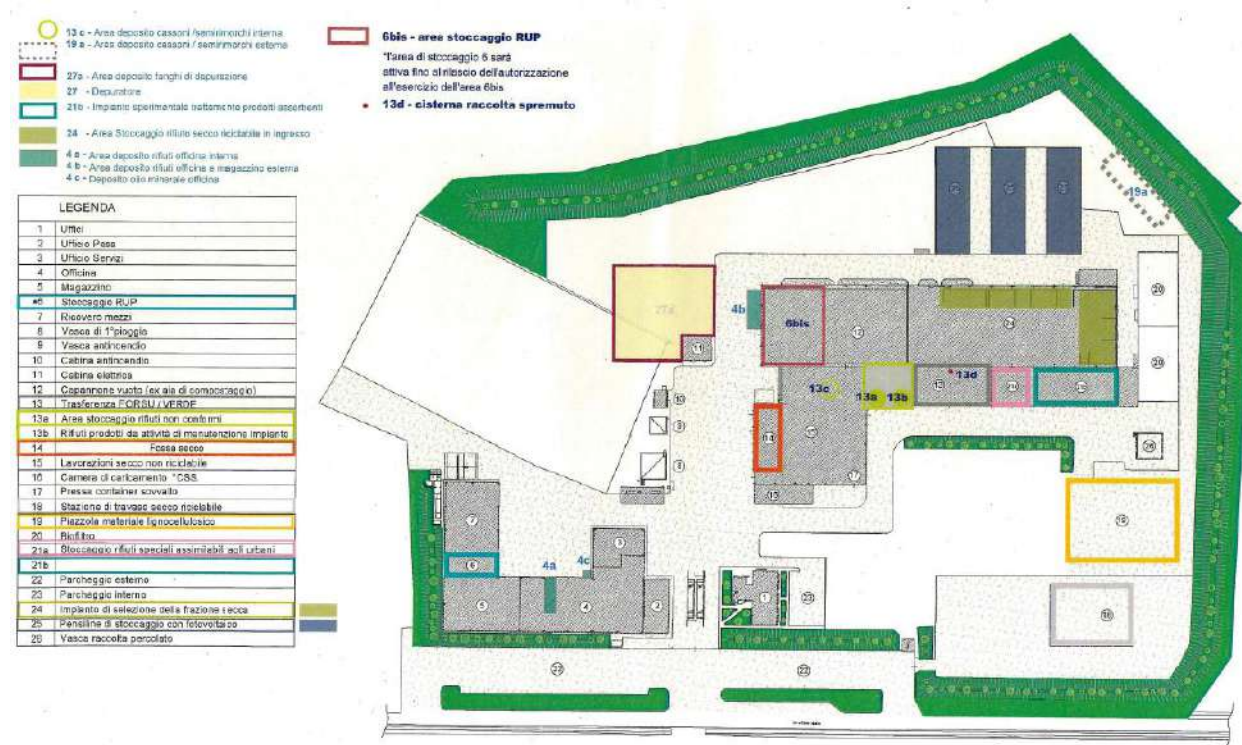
Allegato B22.1 – Planimetria dello stabilimento – Stato approvato
